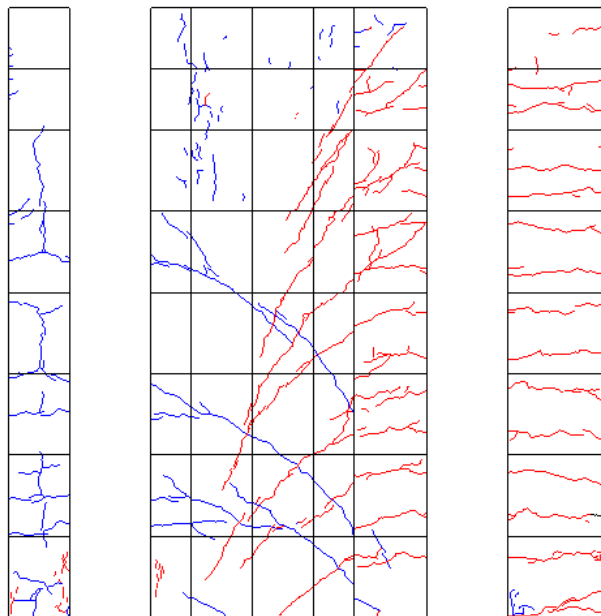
R=1/67 ひび割れ図
